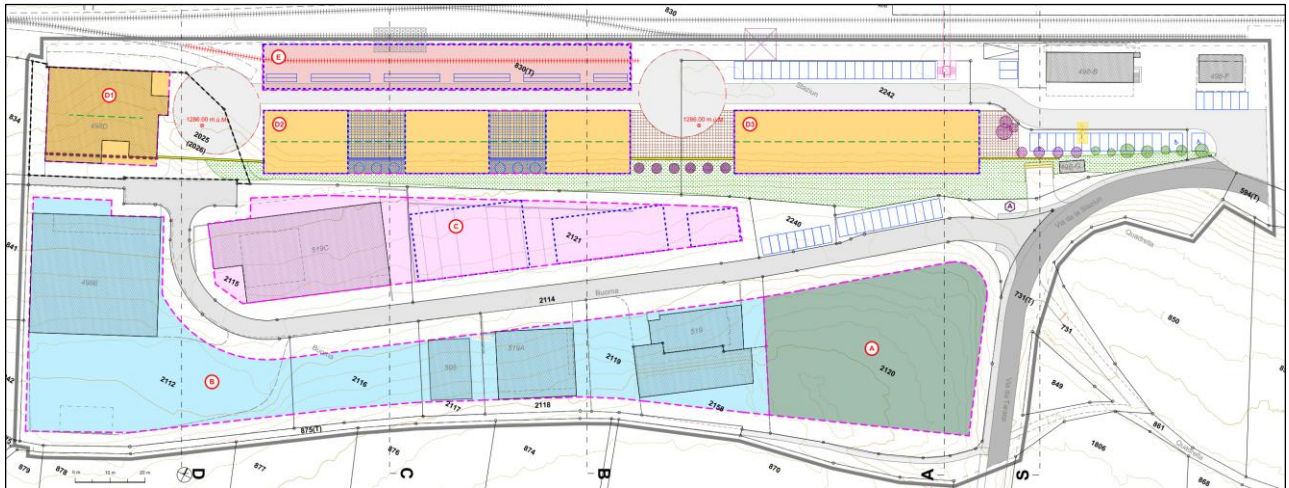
Quartierplan 2025 - Gestaltungsplan Situation
